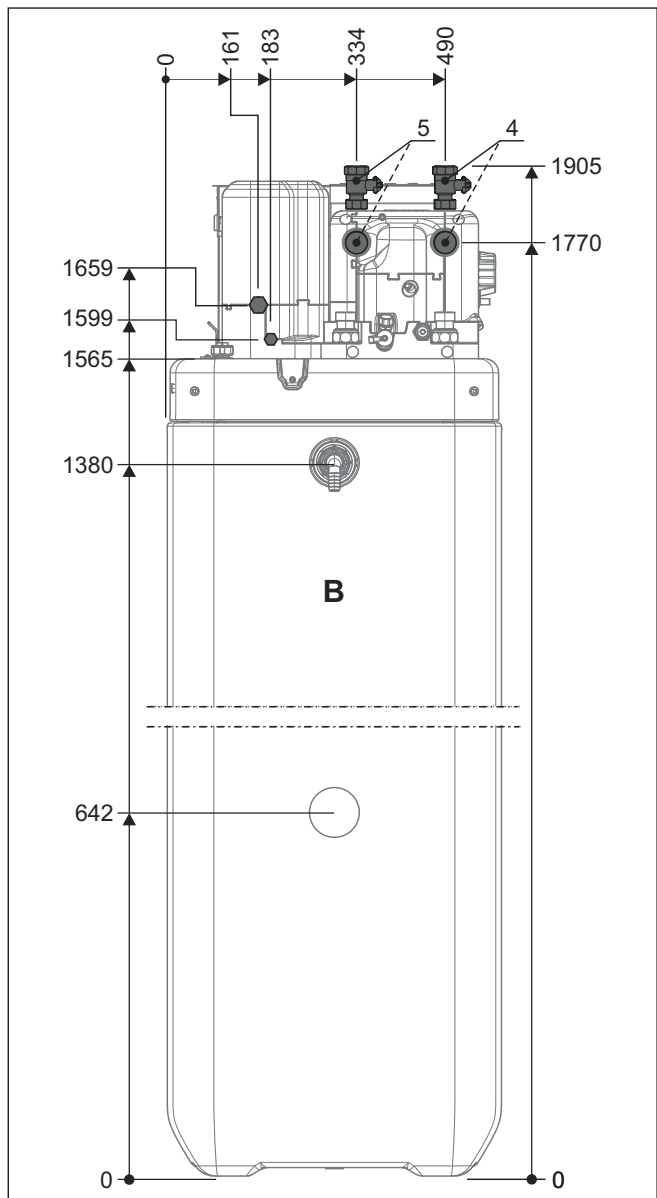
Dimensions vue latérale...04P30D/...08P30D
